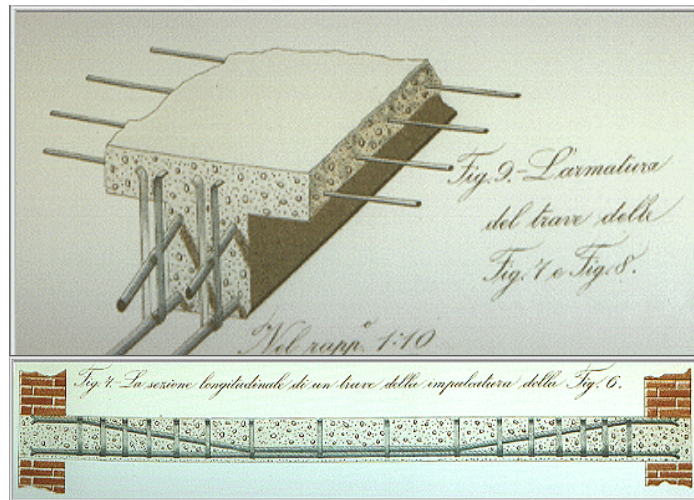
Detalhe da armadura de uma viga e seção longitudinal de uma viga do sistema Hennebique. FONTE: <http://www.sacs.it/tesi/c0423.htm>
